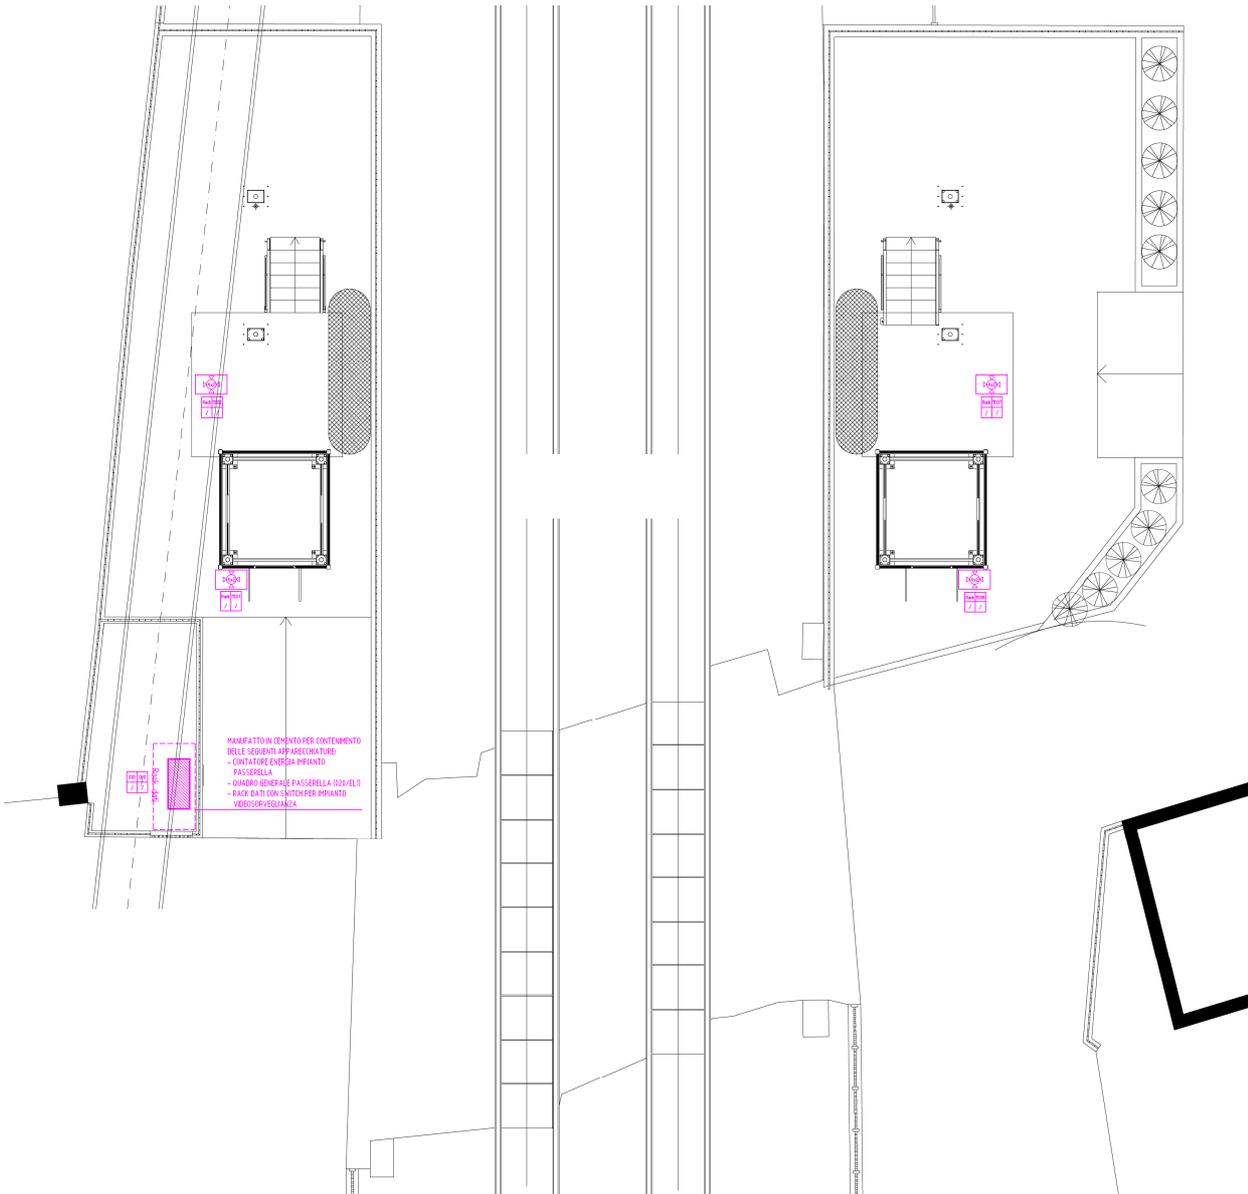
Estratto planimetria generale impianto videosorveglianza al piano terra
